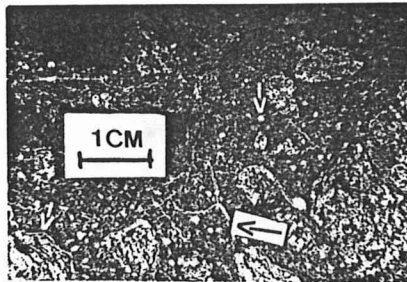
Microfissuramento não orientado da argamassa da base de concreto/White Martins. Os poros e as fissuras encontram-se preenchidos com material branco (carbonato e gel).
